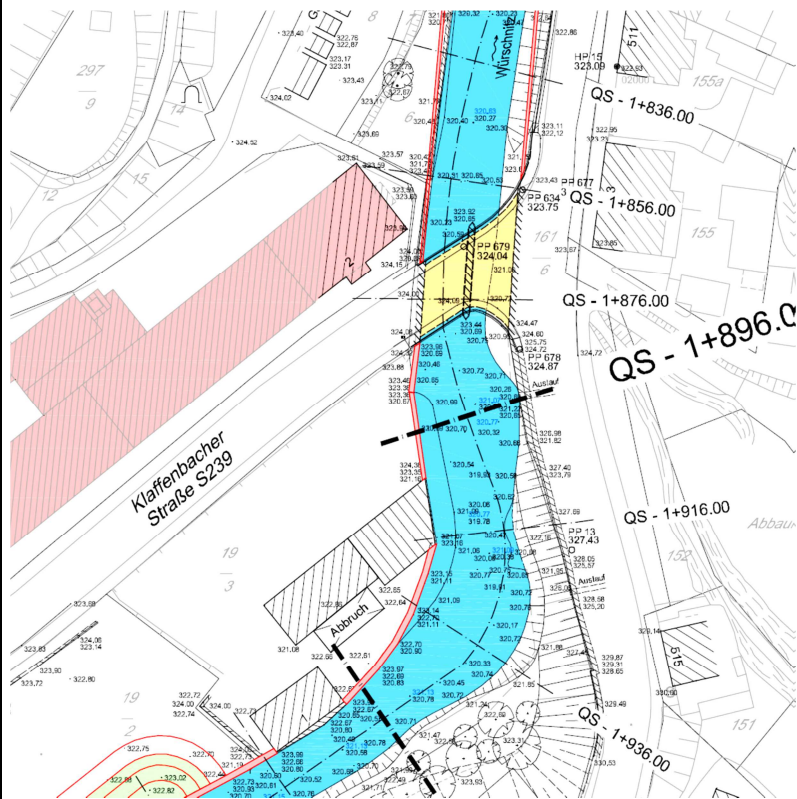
4.5.3: Lageplanausschnitt mit Schnittpur 1+896
